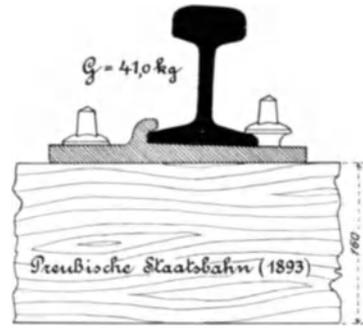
Die Hakenplatte als Befestigungsmittel.
